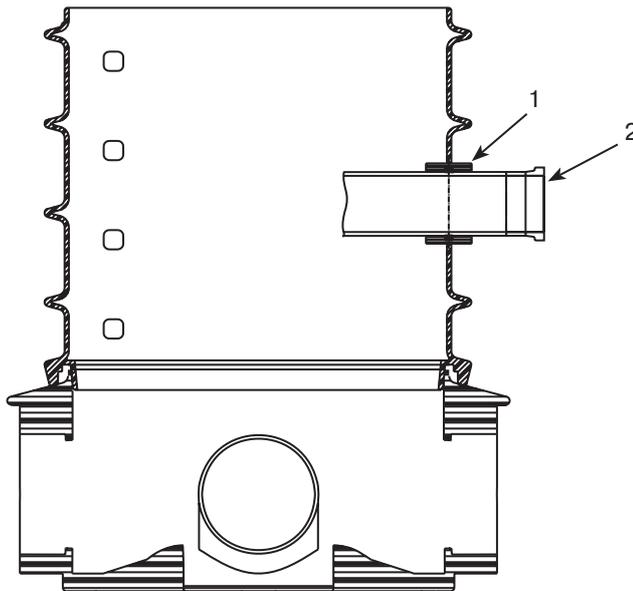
1 – муфта полиэтиленовая, 2 – гладкостенная ПЭ труба
